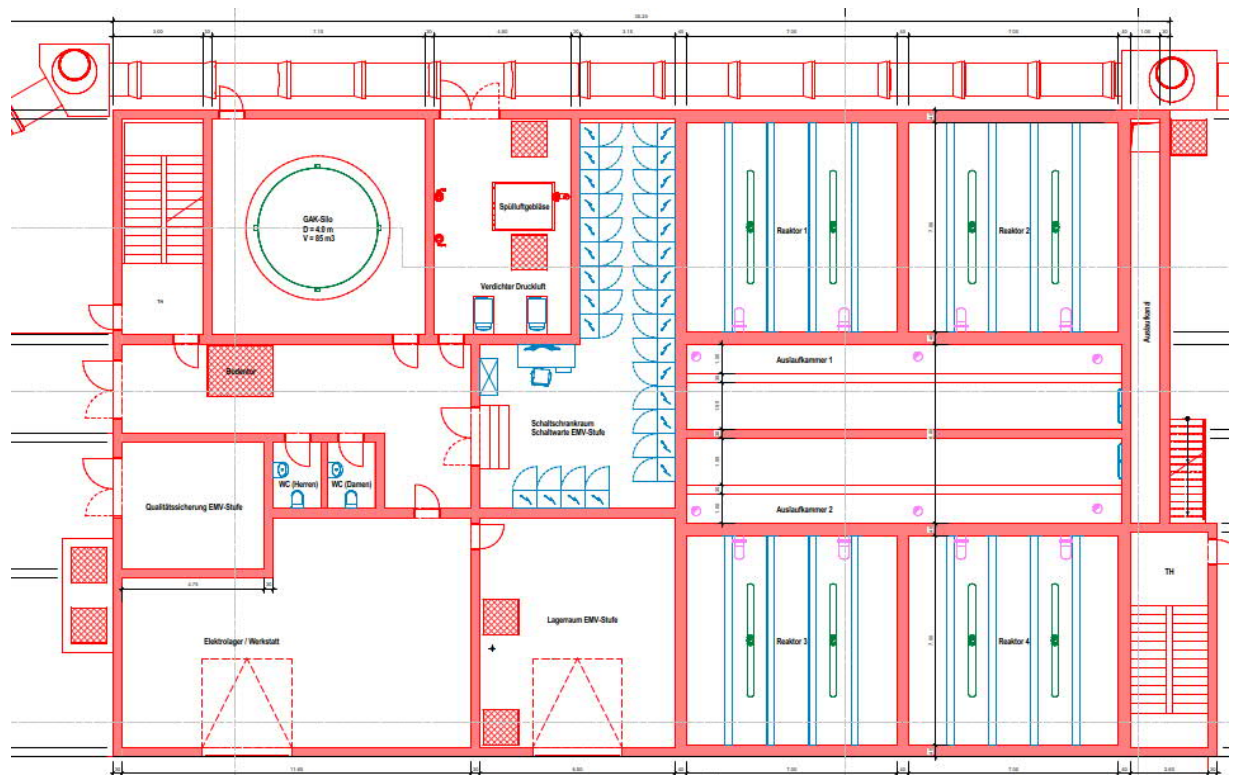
Ausschnitt Grundriss EG
